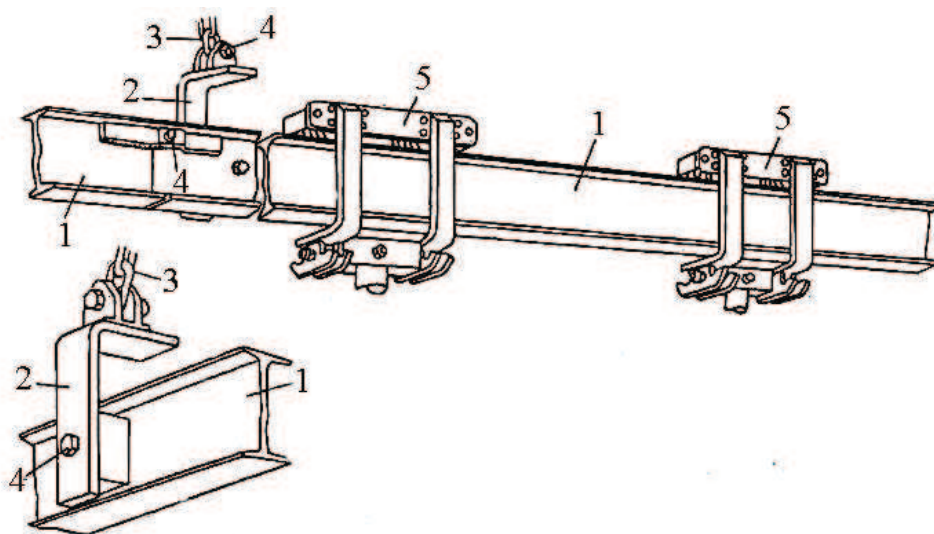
Схема подвески монорельса в выработках, пройденных без крепления или закрепленных бетоном: 1 – двутавровая балка; 2 – кронштейн; 3 – цепь для подвешивания кронштейна к кровле или крепи выработки; 4 – крепежные болты; 5 – каретка
